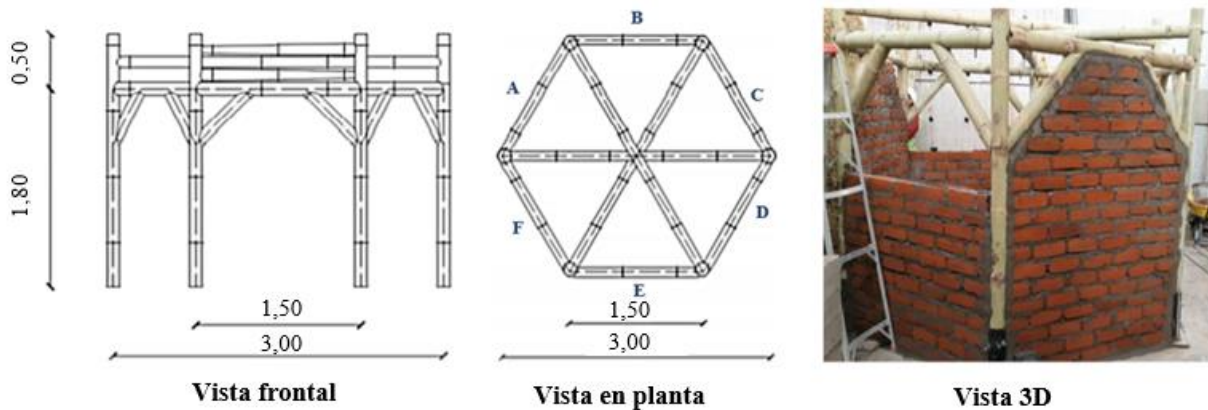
Vistas del modelo físico - estructura espacial hexagonal (Ej. muestra 2). A: Cara 1 de la estructura con altura de mampostería de 1,8m; B: Cara 2 de la estructura con altura de mampostería de 1m. C: Cara 3 de la estructura con altura de mampostería de 1,8m; D: Cara 4 de la estructura con altura de mampostería de 1m. E: Cara 5 de la estructura con altura de mampostería de 1,8m; F: Cara 6 de la estructura con altura de mampostería de 1m.
